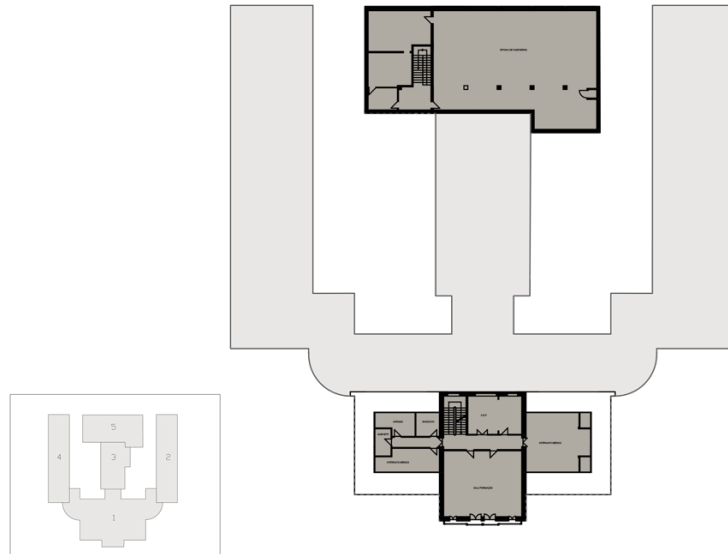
Primera planta bloques 1 y 5. Análisis de usos. En marrón área de acceso restringido a personal autorizado. Plano base oficial facilitado por el Ingeniero Paulo Costa. Análisis gráfico realizado por Laura Castro.
